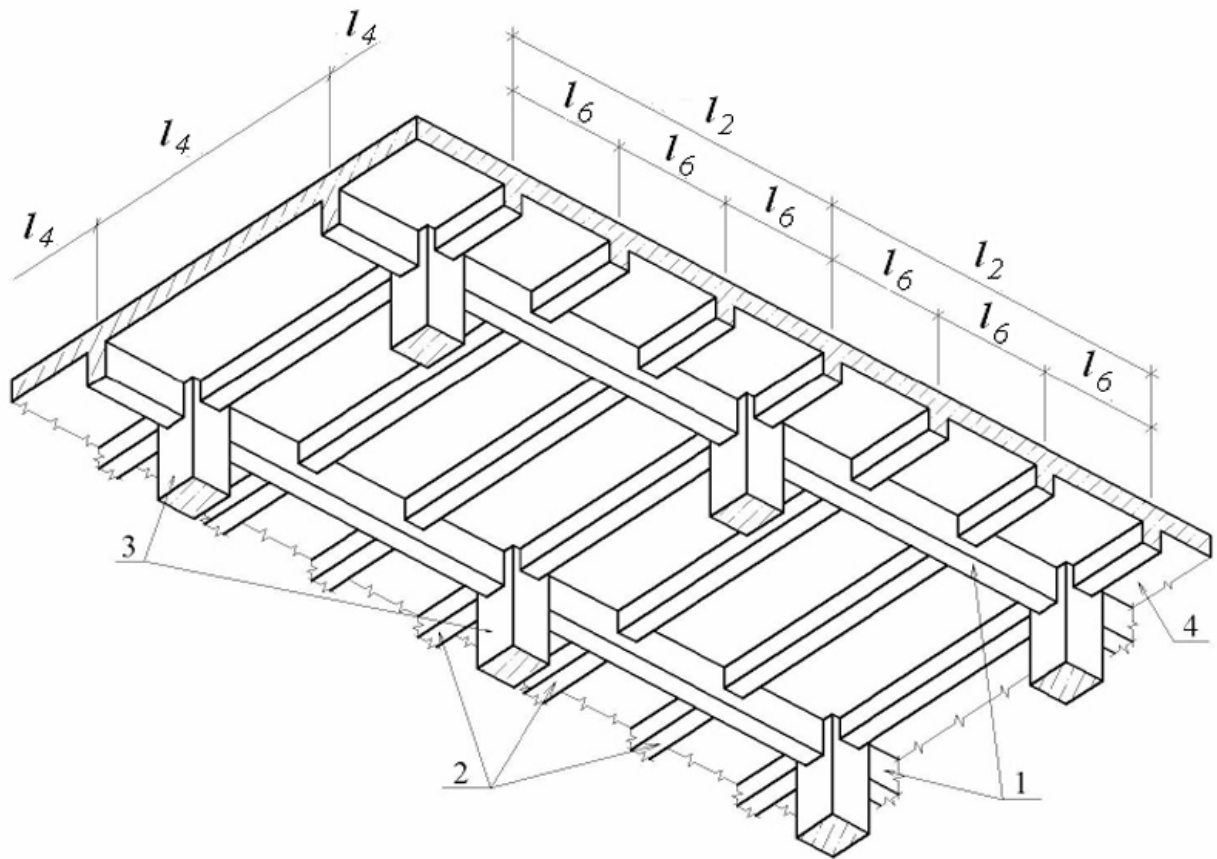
Монолітне ребристе перекриття з балочними плитами: 1 - головні балки; 2 - другорядні балки; 3 - колони; 4 – плита
